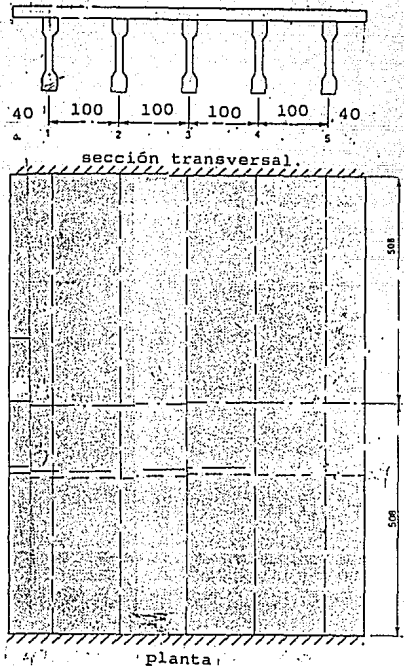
Sección transversal y planta del puente. (Ref 1).
